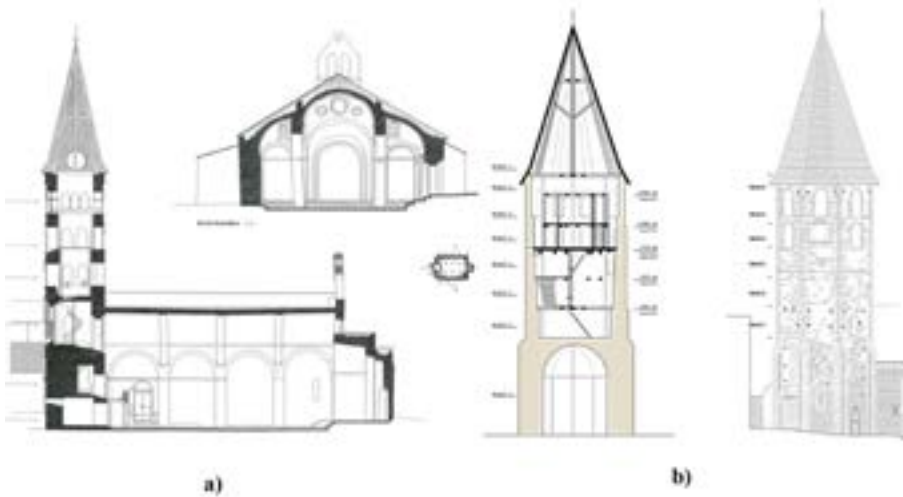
Planimetria d'intervencion en patrimoni arquitectonic.
